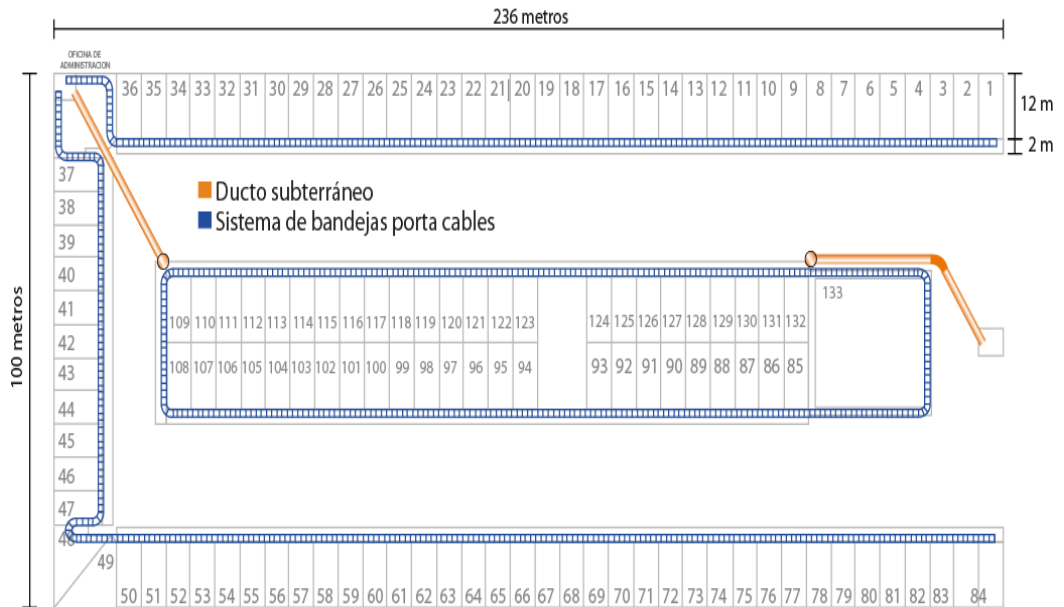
Plano de sistema de bandejas metálicas porta cables
